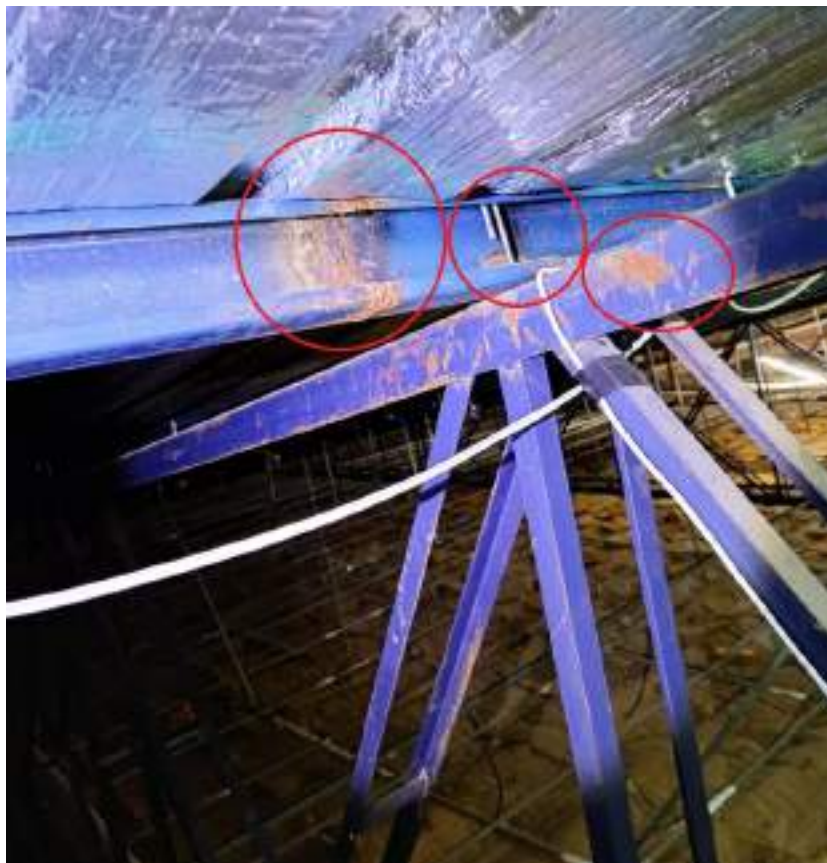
Elementos de fixação da estrutura de cobertura do bloco do plenário PL1
